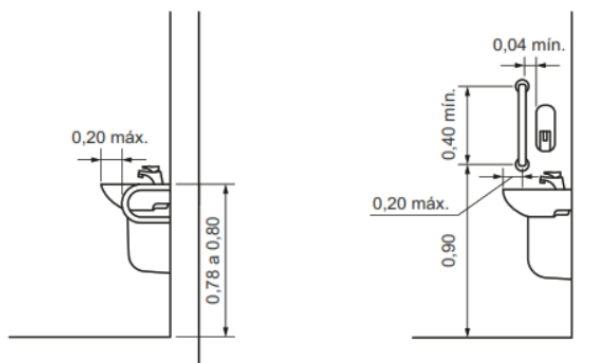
Vista lateral de lavatório com barra vertical e horizontal
